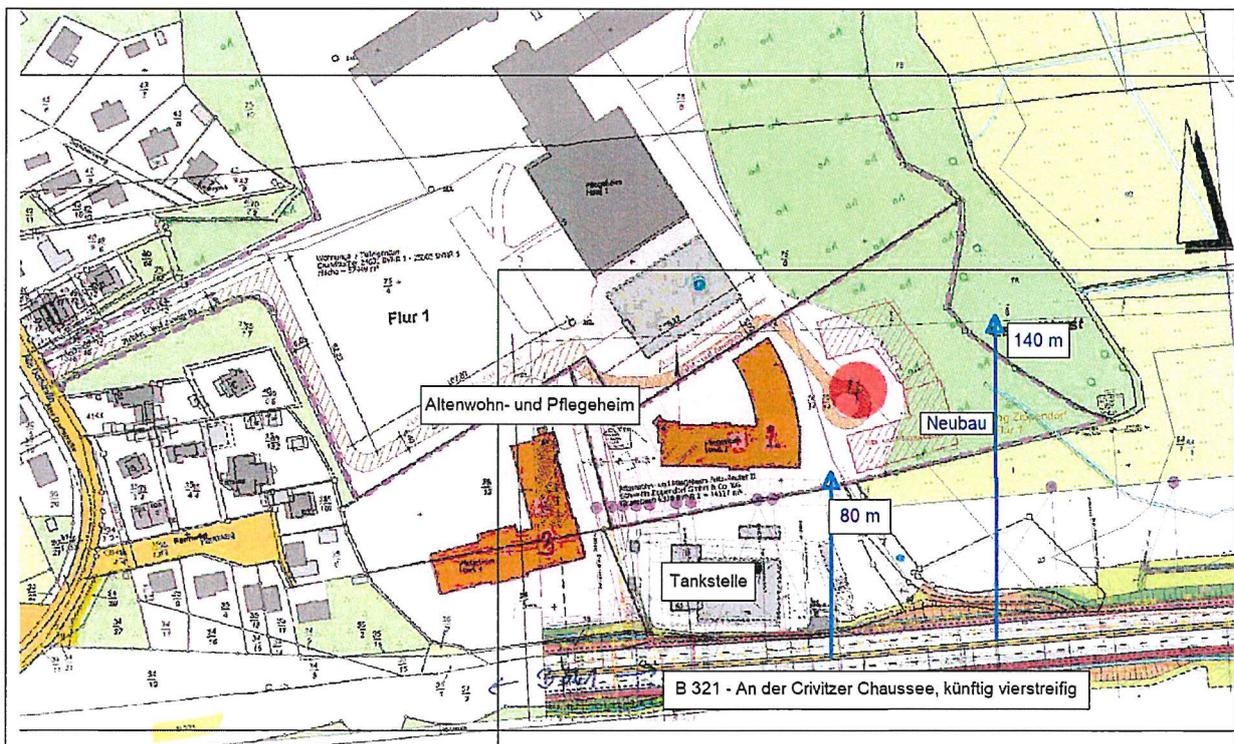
Lageplan – Neubau an der Markierung ,4' geplant
